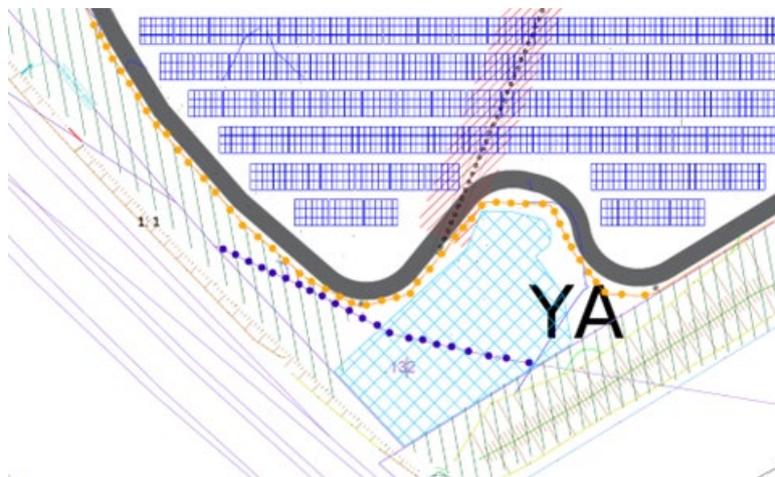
Portion sud-ouest du plan d'implantation de la centrale photovoltaïque au sol de La Roche-sur-Yon
